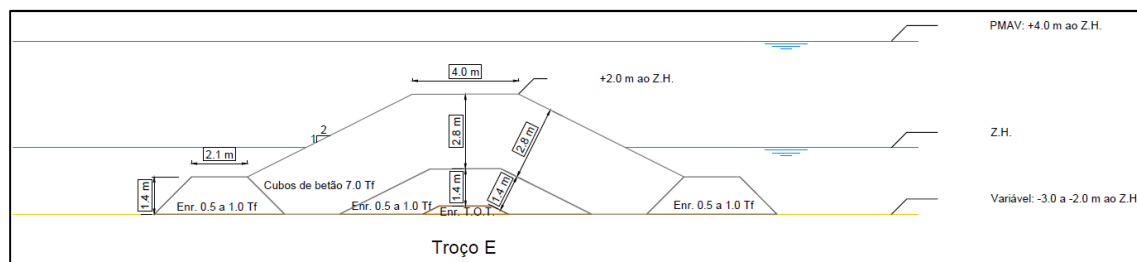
Secção transversal de esporão em "I" com 150 m: Troço E
